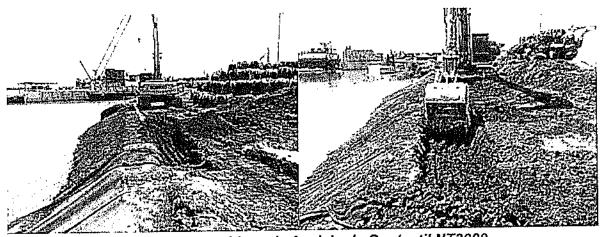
Llave de Anclaje de Geotextil NT3000
